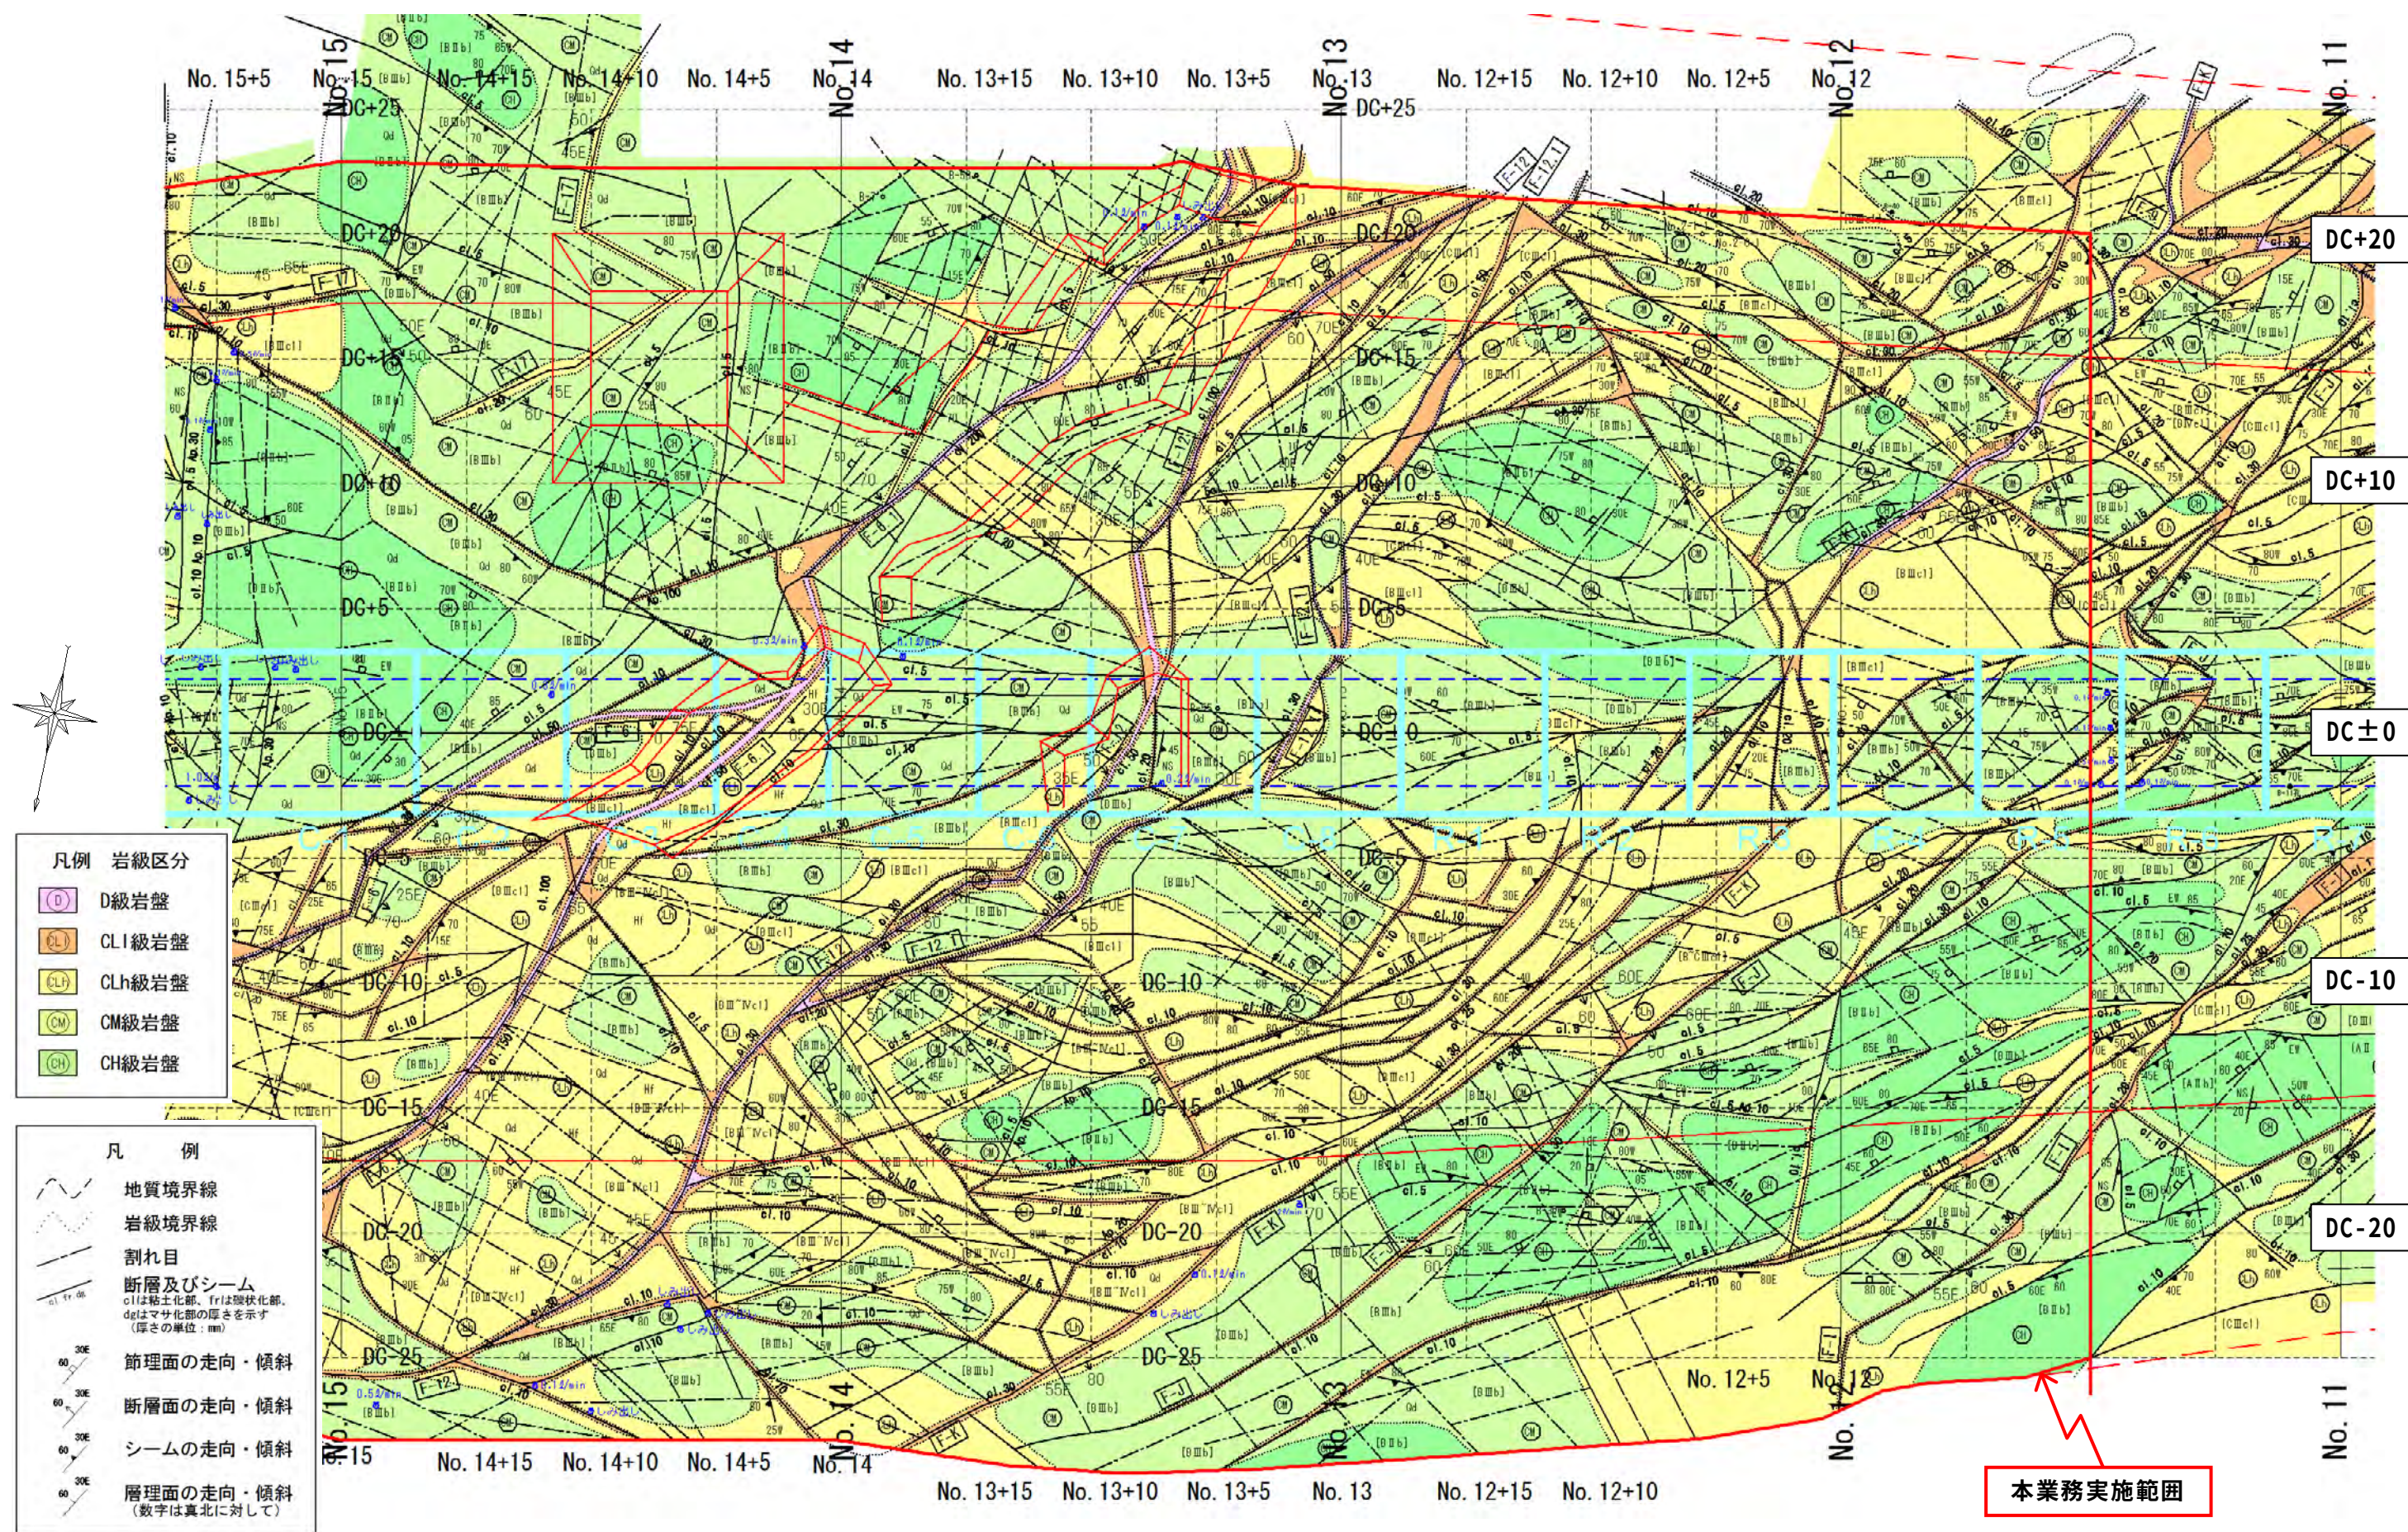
岩盤スケッチ平面図 (岩級区分、河床部～右岸部)
